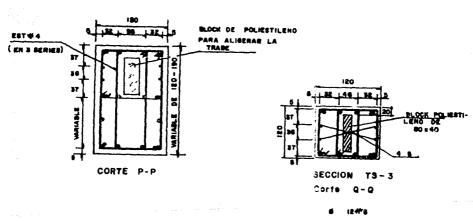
ARMADO PARA LA TRABE DE MASTILES.
